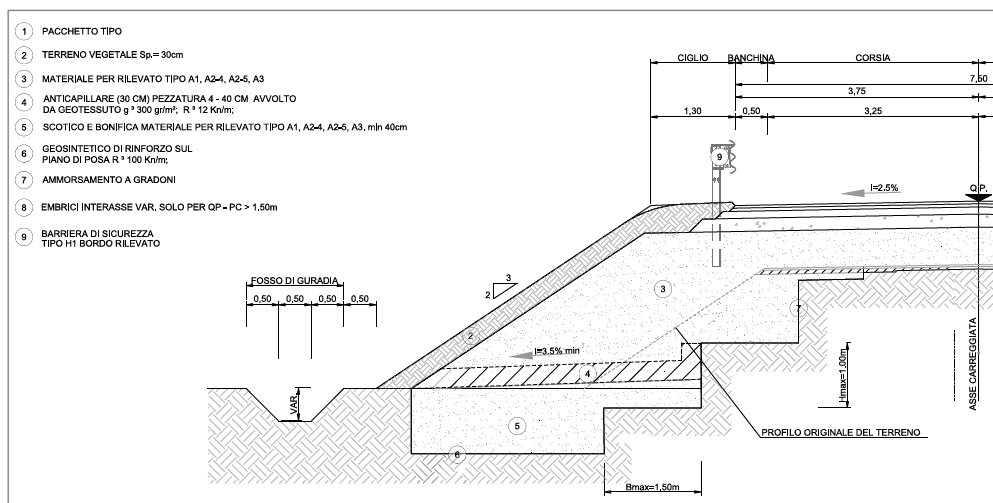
Sezione tipo costruttiva del rilevato stradale di nuova esecuzione
